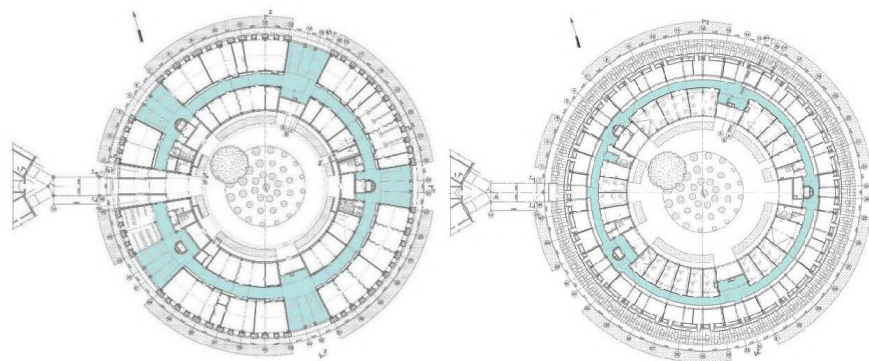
План 1 этажа и план 2 этажа павильона «Школа»
